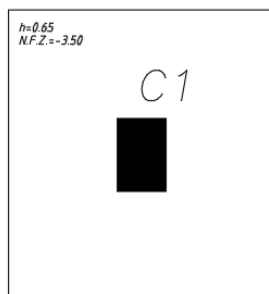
Dimensiones de la zapata C-1 para sistema de muros
